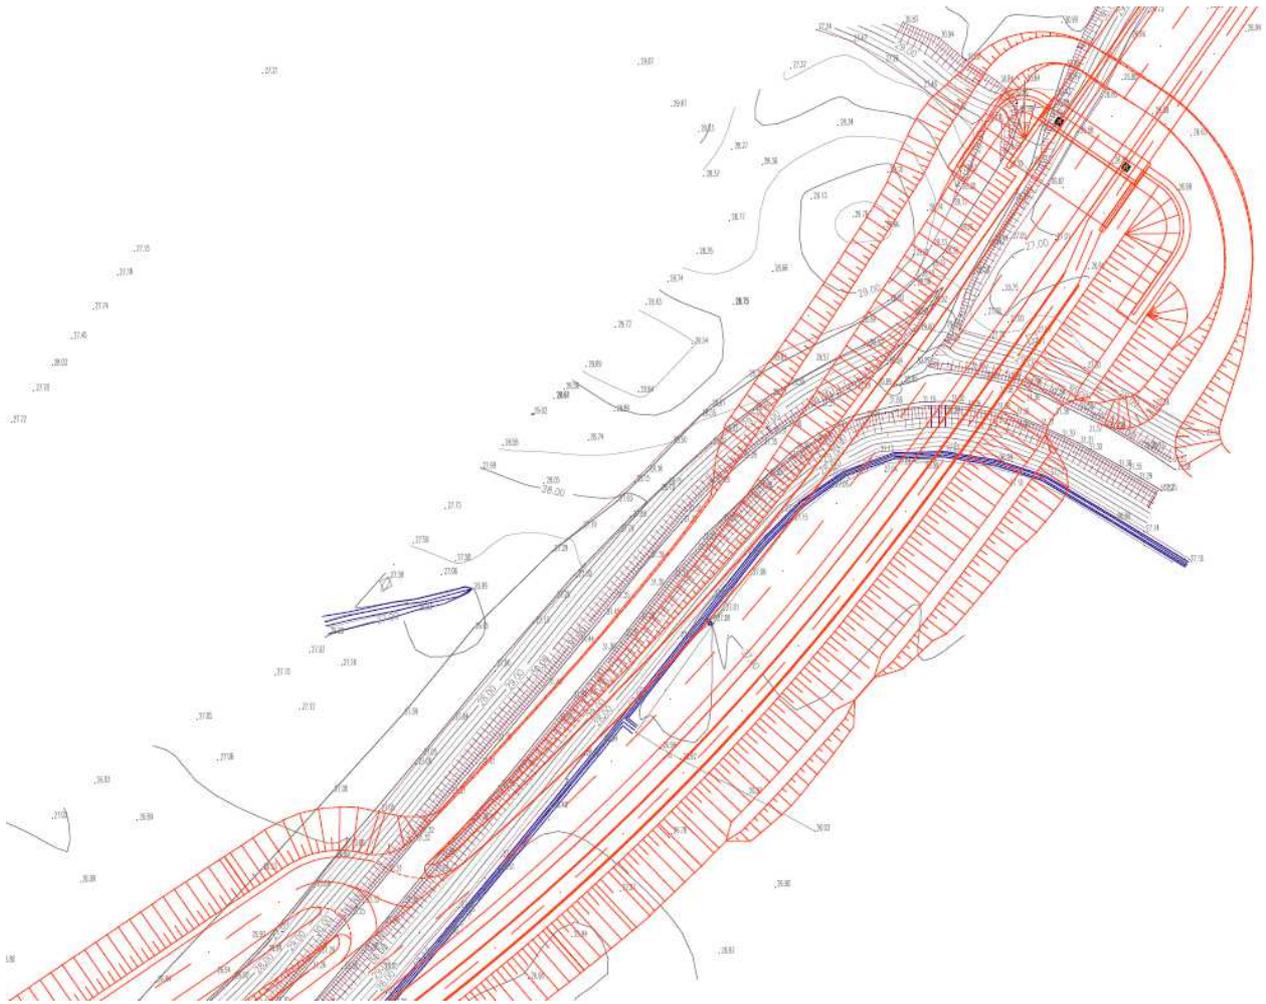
Viabilità arginale di accesso alle casse di espansione)
